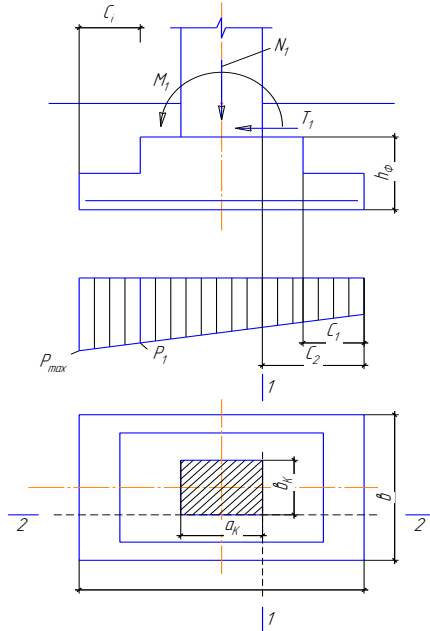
Схема для розрахунку фундаменту на згинання.
